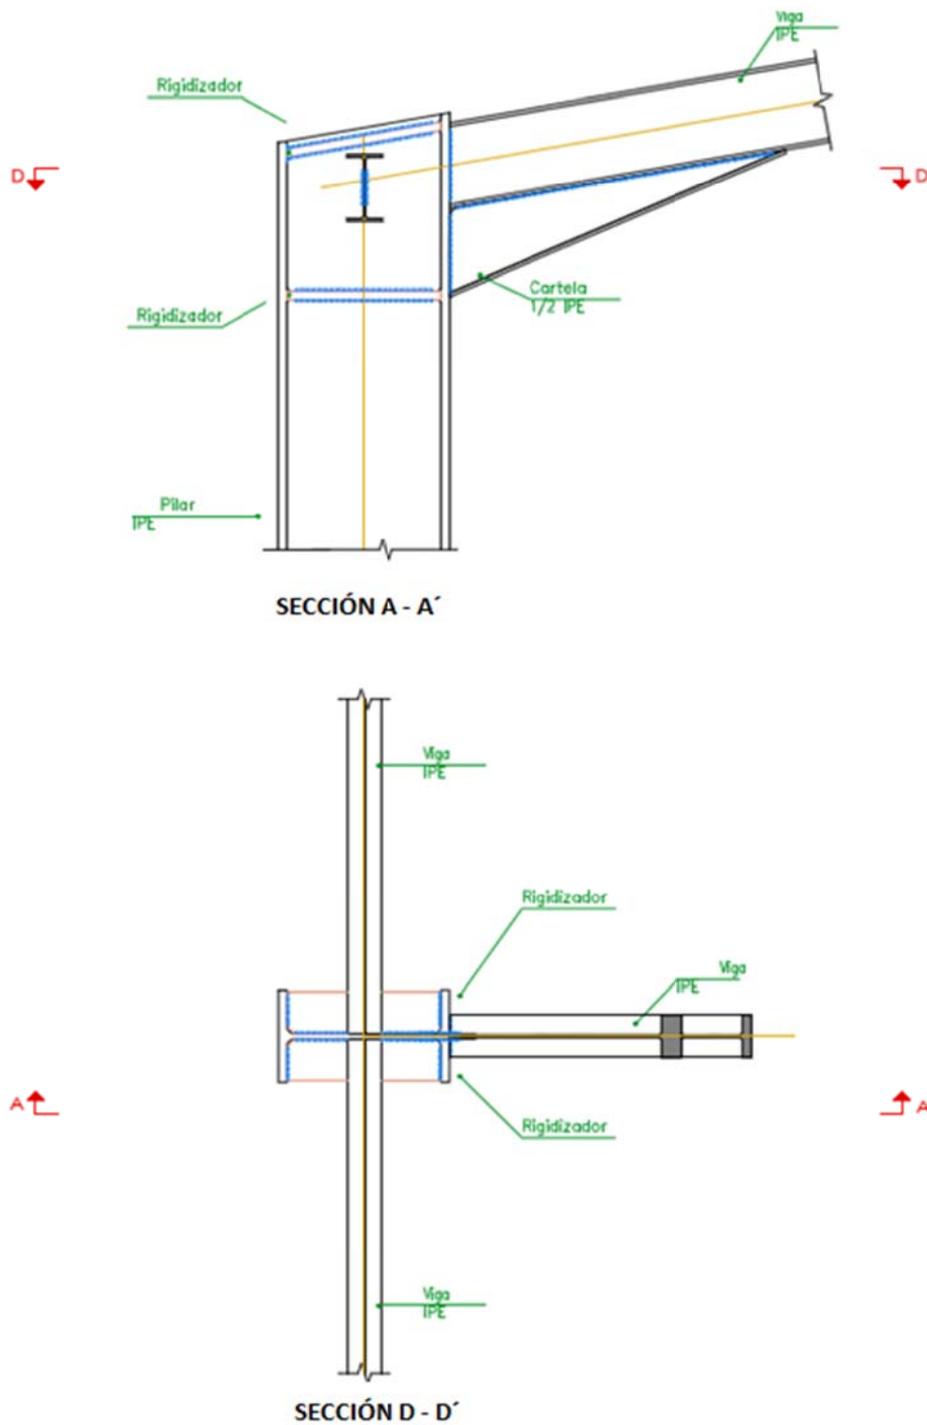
Detalle constructivo de la articulación entre el pilar y la viga de atado.
